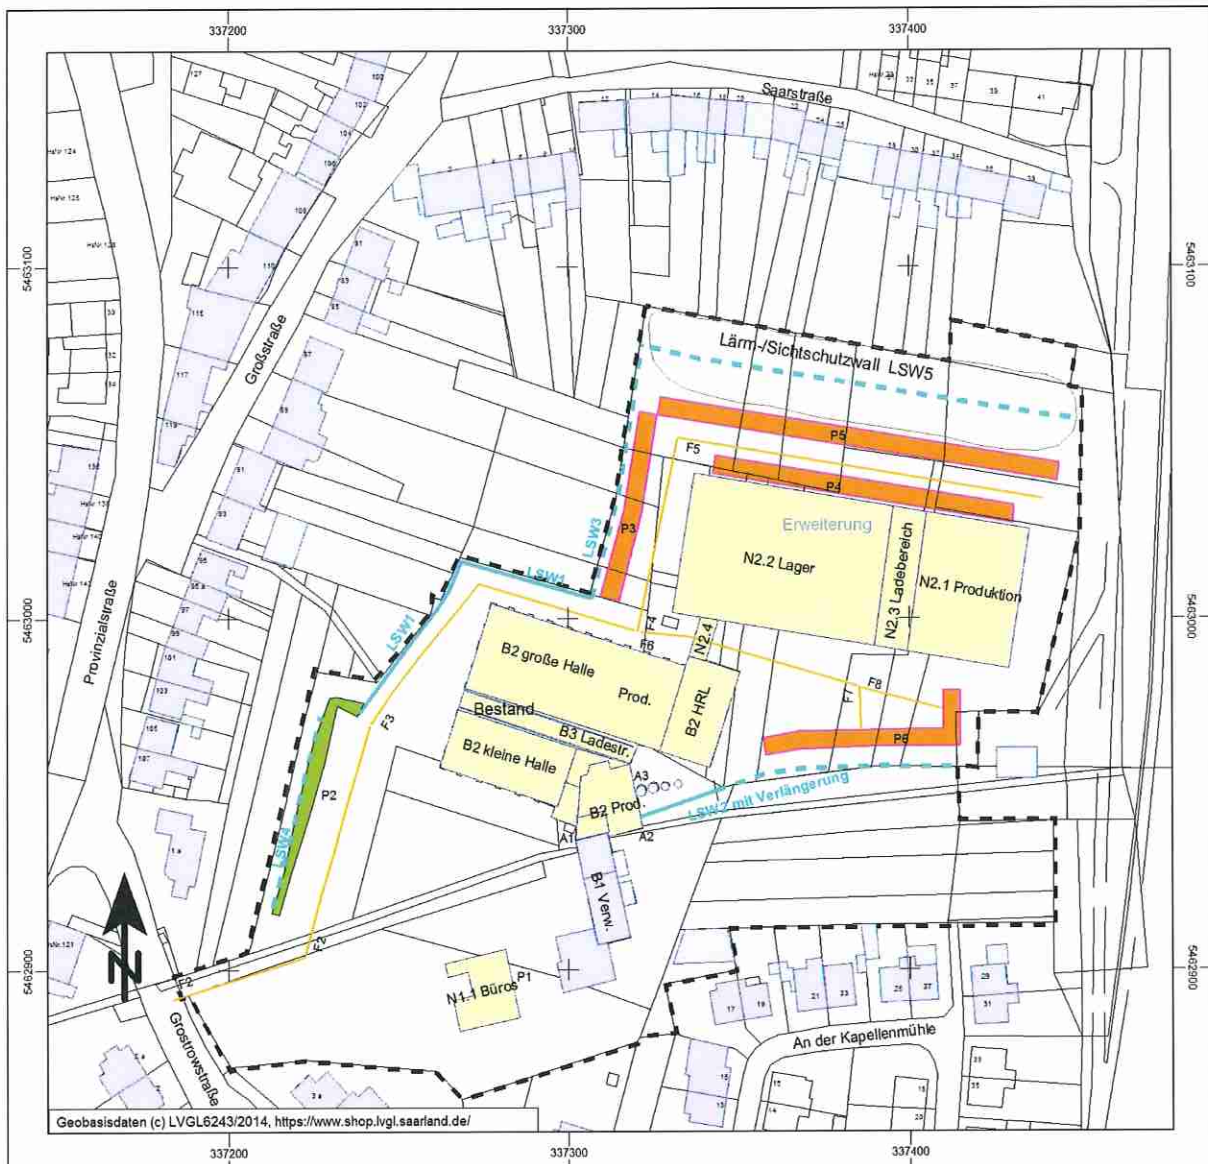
Lage der Lärmschutzwände | ISU Bitburg | 05/2018
